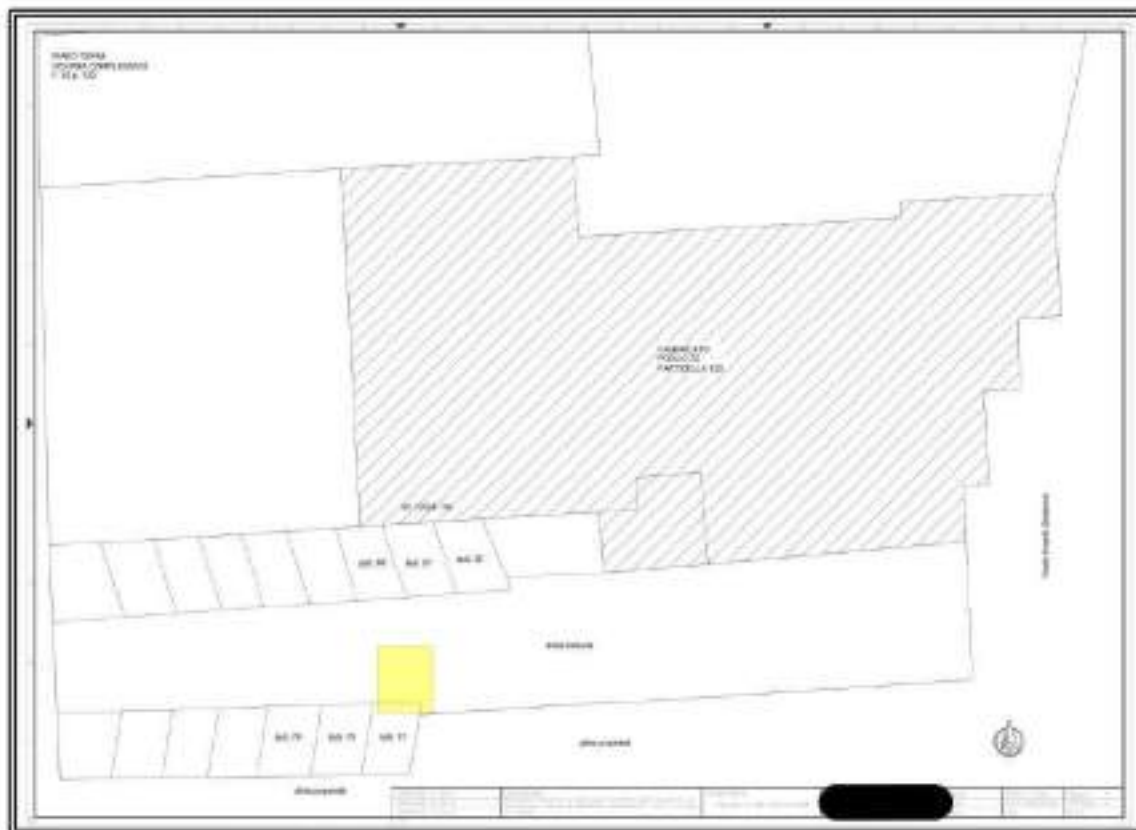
Pianta dell'area parcheggio con evidenziazione del LOTTO1
